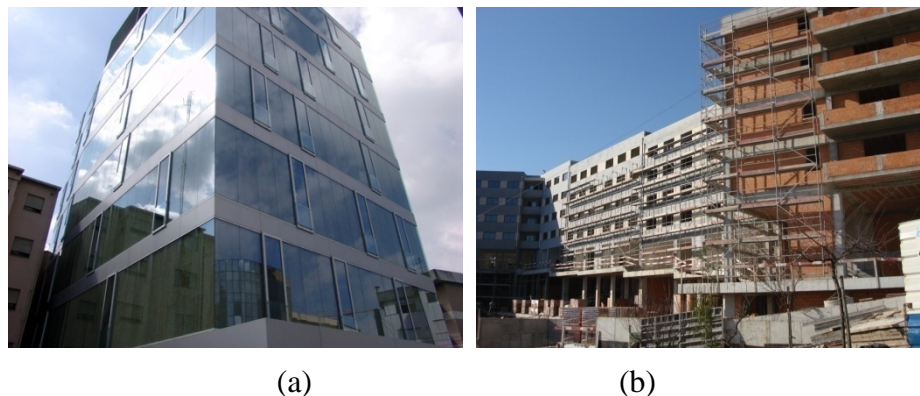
Obras realizadas com Tecnotijolo: (a) Maia Trade Center; (b) Lousadapark (Fonte própria. Fevereiro, 2009).
